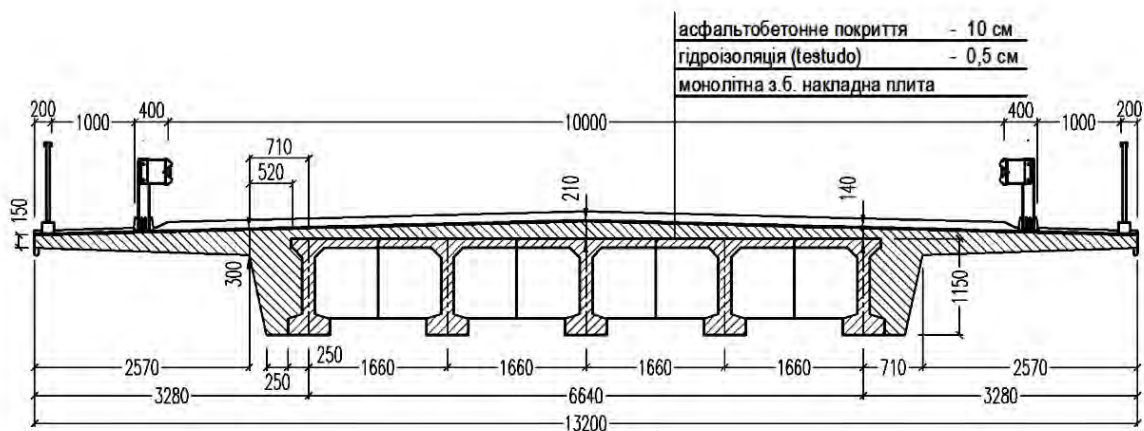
Розширення прольотної будови монолітною залізобетонною накладною плитою з контурними ребрами підсилення крайніх балок (варіант 1)
